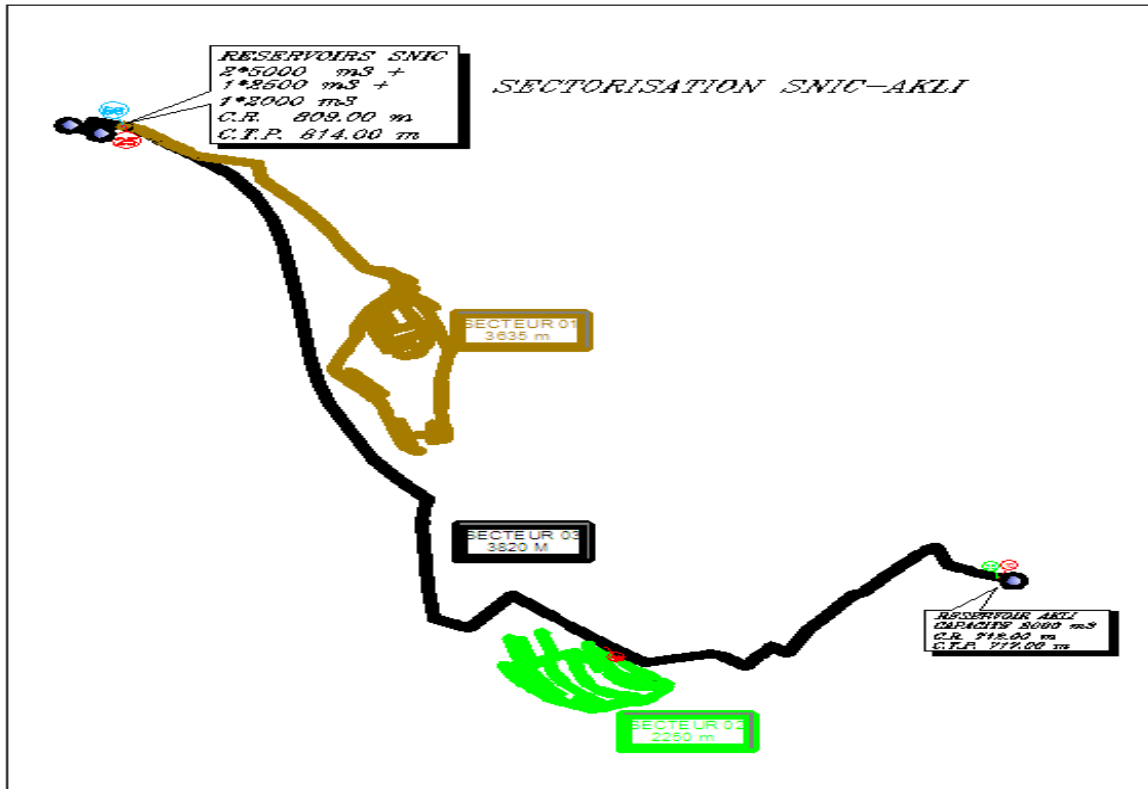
Plan de sectorisation du secteur Snic-Akli.
